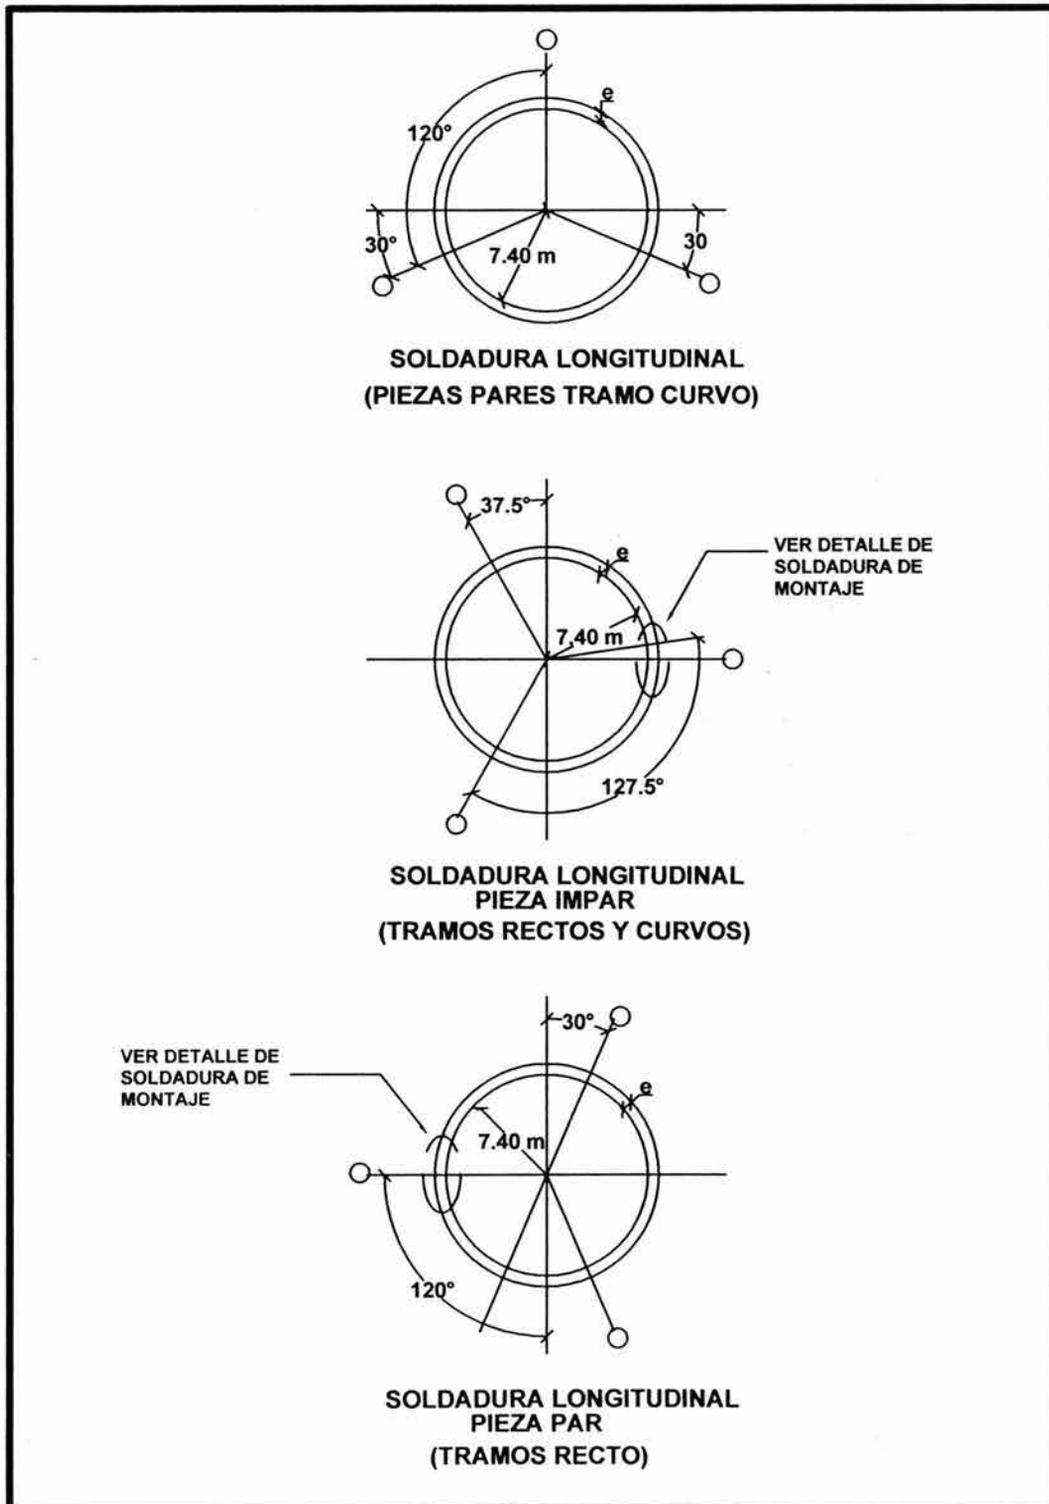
SOLDADURA DE MONTAJE LONGITUDINAL
